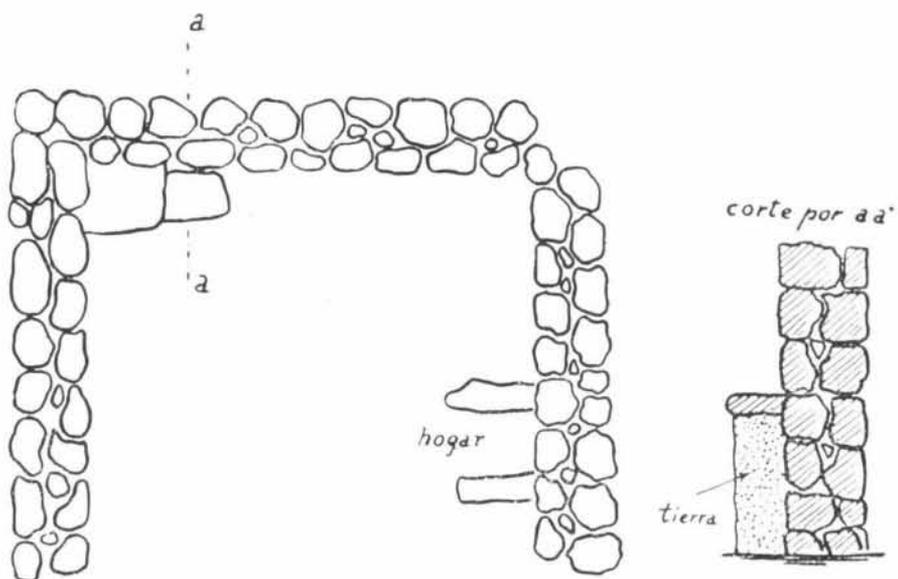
«El Castellar», - Parte del plano de la casa excavada en la Zona E, y corte, en alzado, por a - a.
